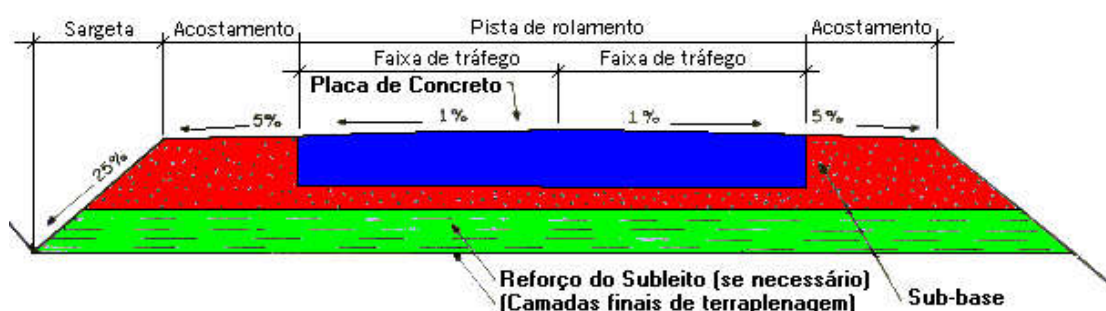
Secção transversal típica de pavimento rígido. Fonte: Marques (2006)
